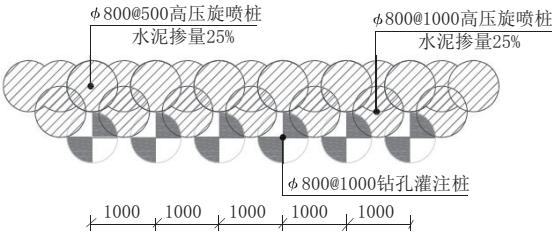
钻孔灌注桩+旋喷桩止水围护平面示意图(单位:mm)
